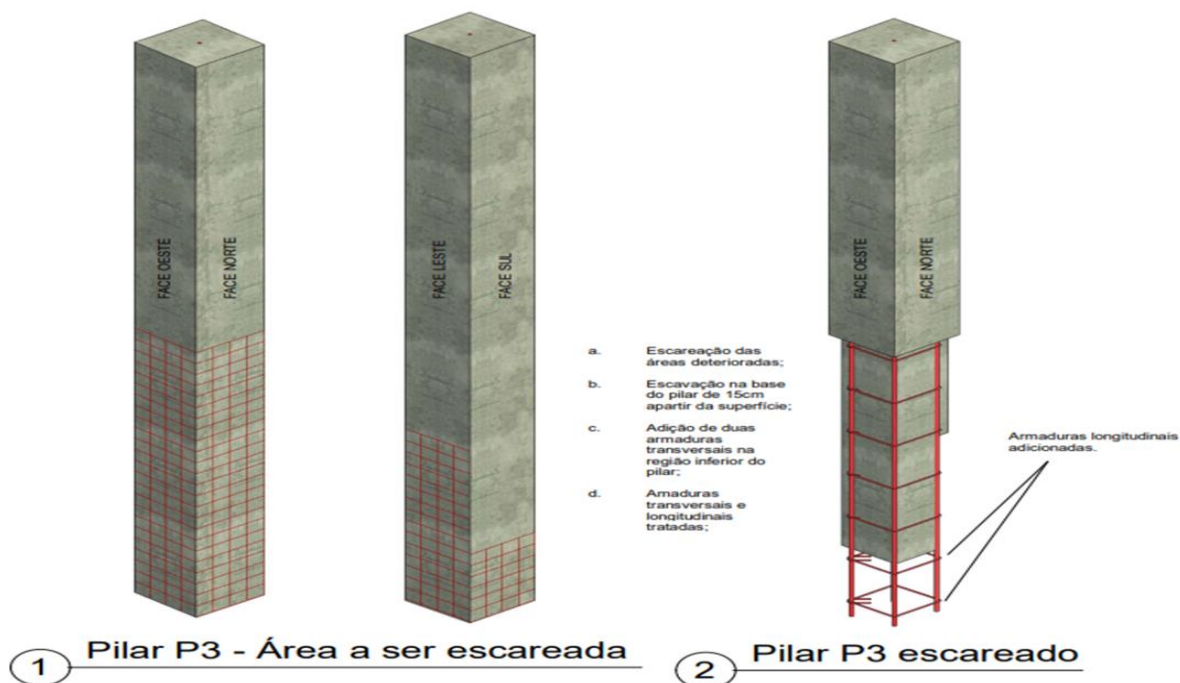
Projeção em 3D da área de intervenção do Pilar 3. Fonte: Autores, 2022.
